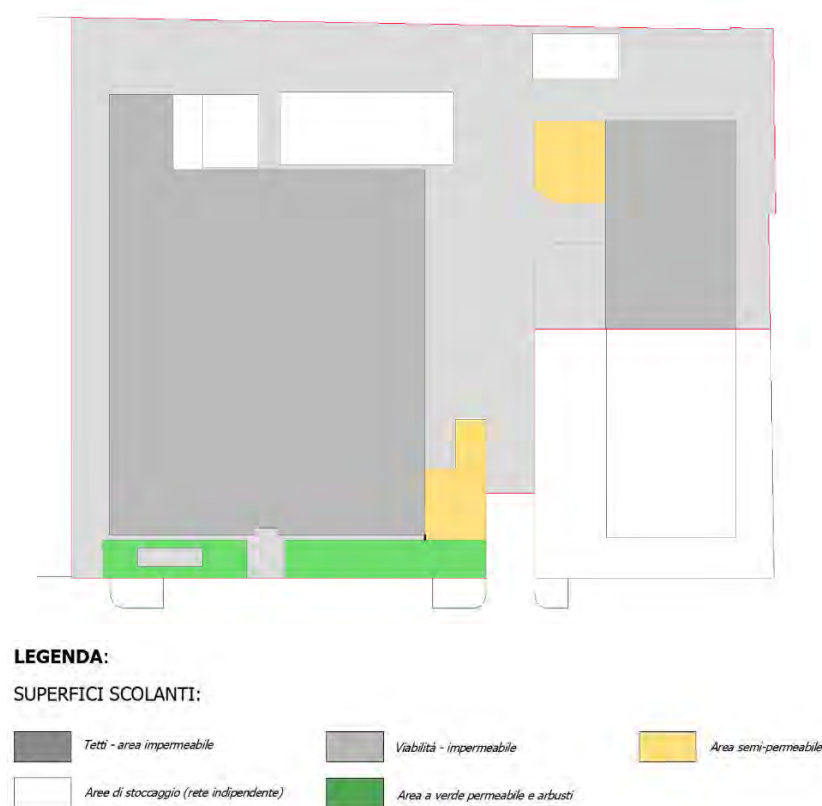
Planimetria stato di progetto – Individuazione aree a diverso uso e scolo
